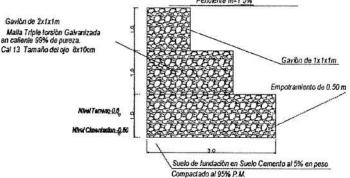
Detalle lateral de muros gaviones a construir en el Río Guatapurí. 11
